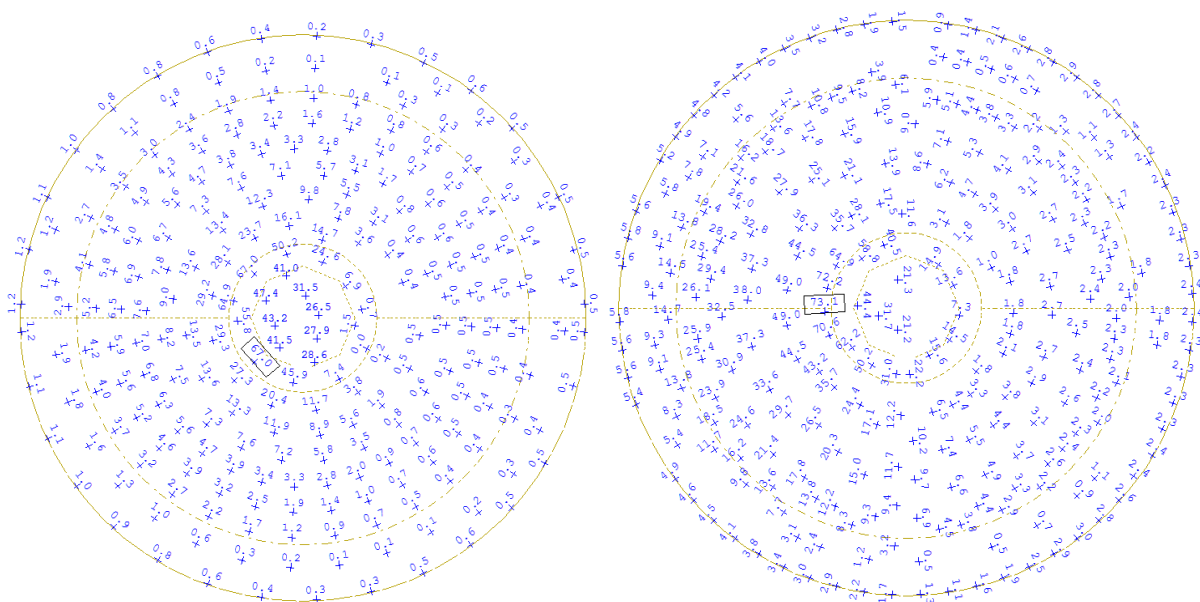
Bewehrung auf der Außenseite des Deckels (Draufsicht auf das Betonbucket; Extremlastfall 1 – Luvseitig, Fußpunkte eingespannt)
